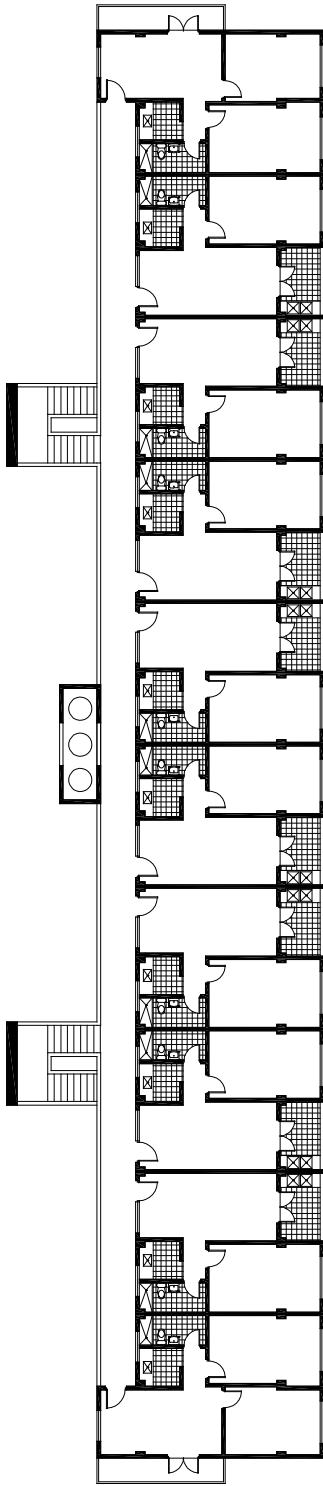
Planta típica del bloque de apartamentos. Fuente: Elaboración propia.
